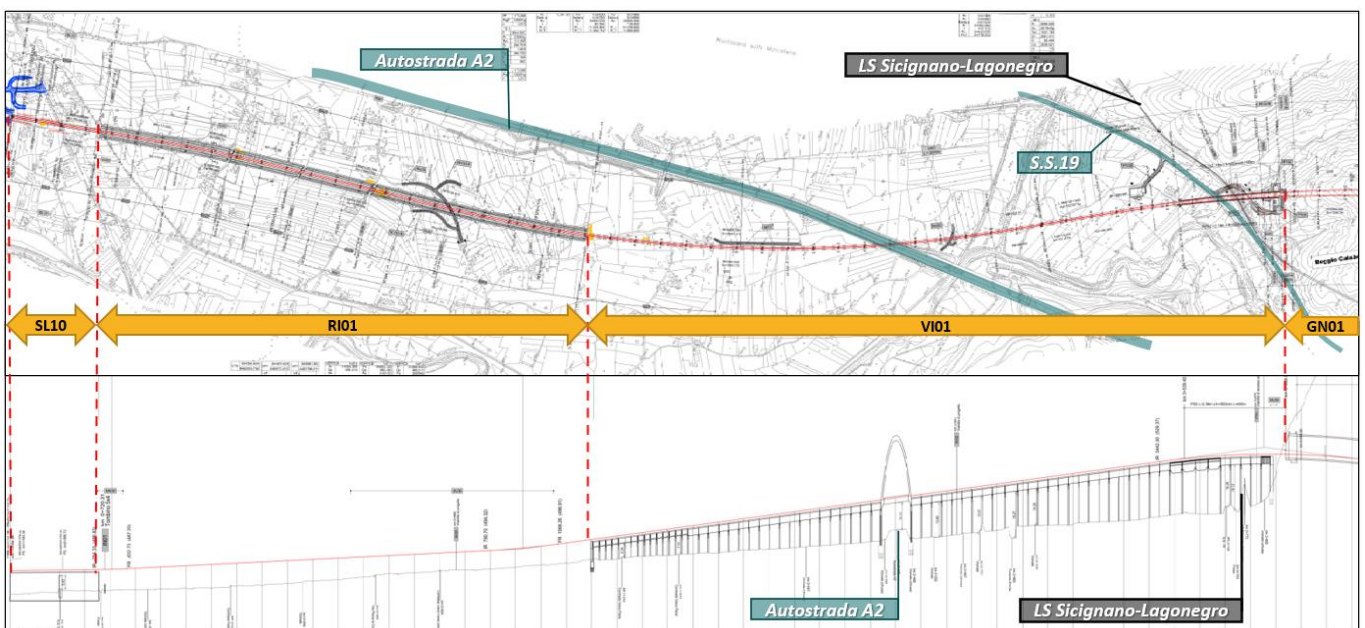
Planoprofilo di progetto da km -1+094 al km 3+940
